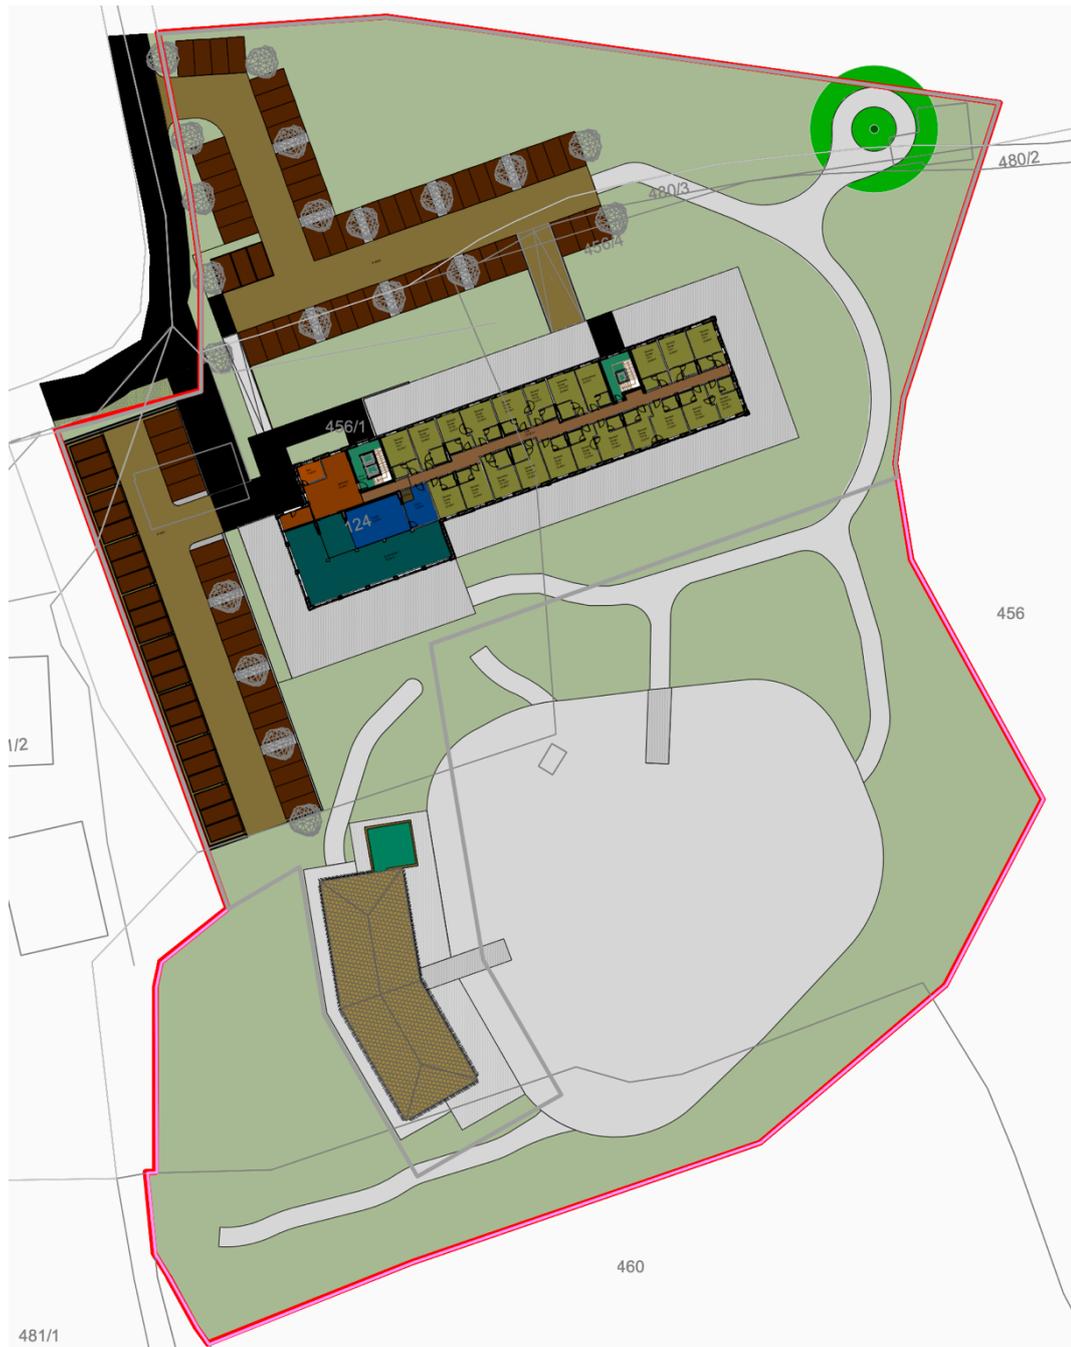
Prüfbereich (rote Umgrenzung) des Umweltberichts ‚Hotel Straßerhof‘, Plandarstellung gem. HP Ingenieure ‚Lageplan mit Umgriff B-Plan, Stand 12.12.2024‘ (Hinweise: Der unterirdisch verlaufende Verbindungskorridor ist in dieser Draufsicht nicht dargestellt, Darstellung unmaßstäblich, Inhalte farblich verändert)
